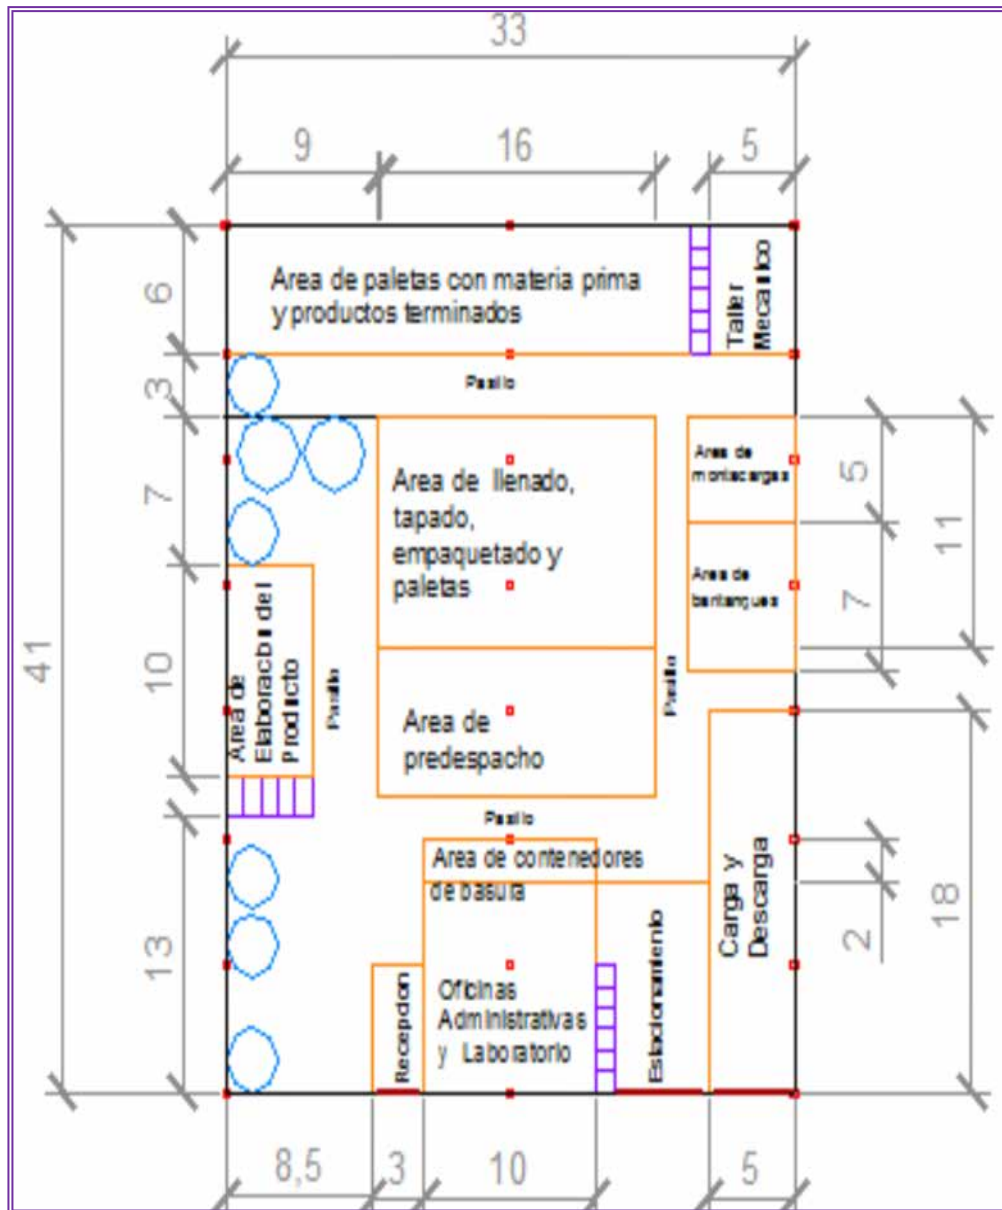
Vista de planta, Layout propuesta de la empresa INVERSIONES VEREEN, C.A. Fuente: Elaborado por Duarte y Vásquez (2017).
